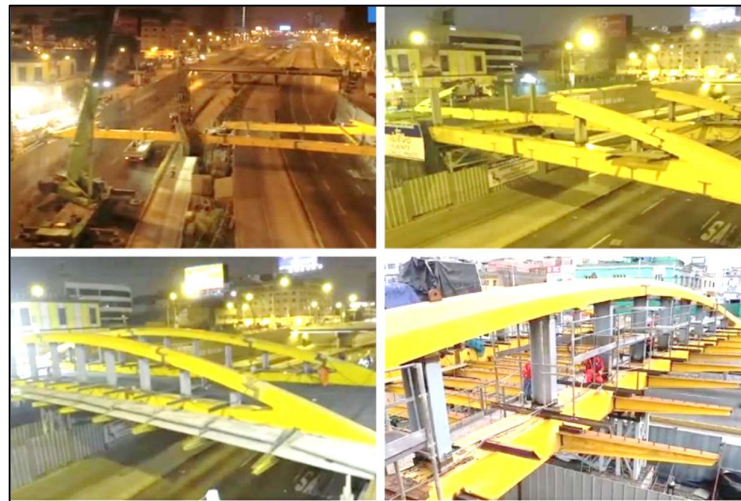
Montaje y Lanzamiento del Puente Chuquicara
